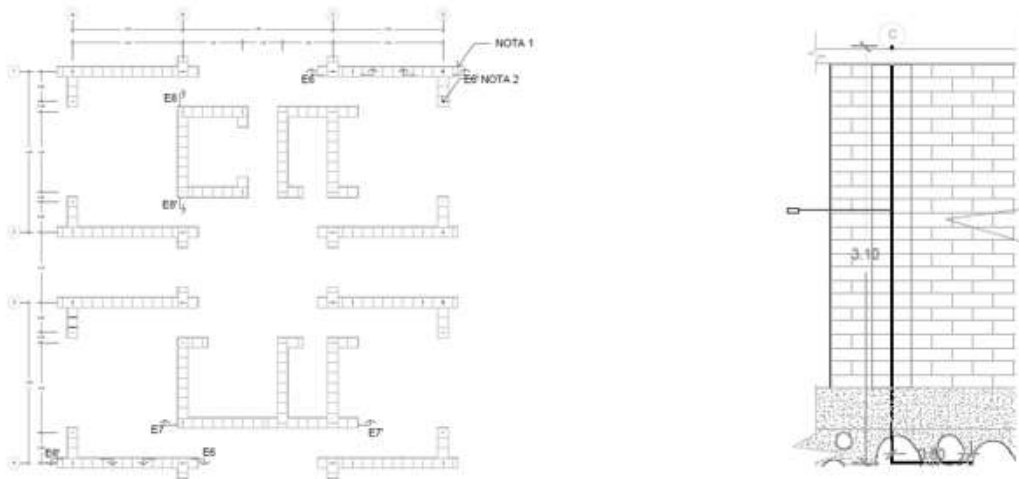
Muros y Estructura de refuerzo interno vertical dos tres dormitorios
